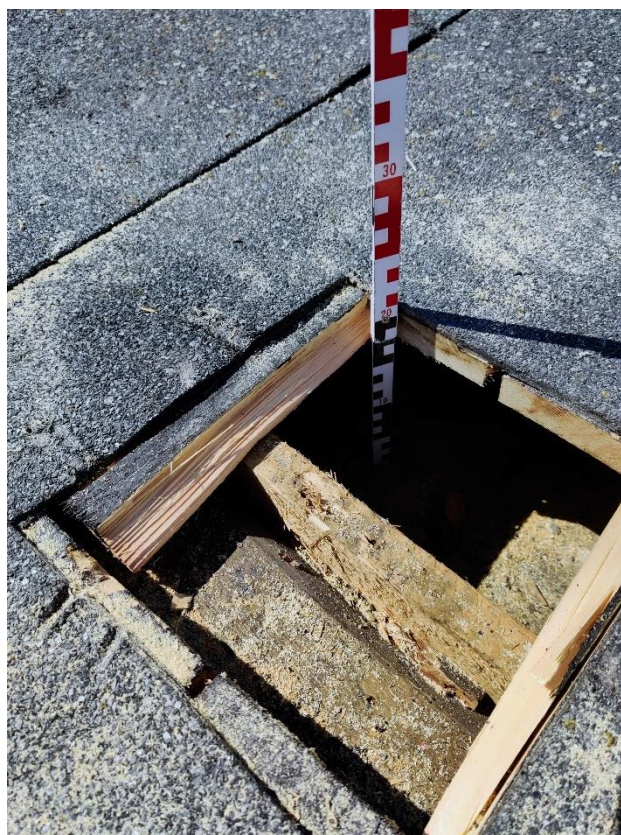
Izolacja przeciwwilgociowa (papa asfaltowa w poziomie 0).
